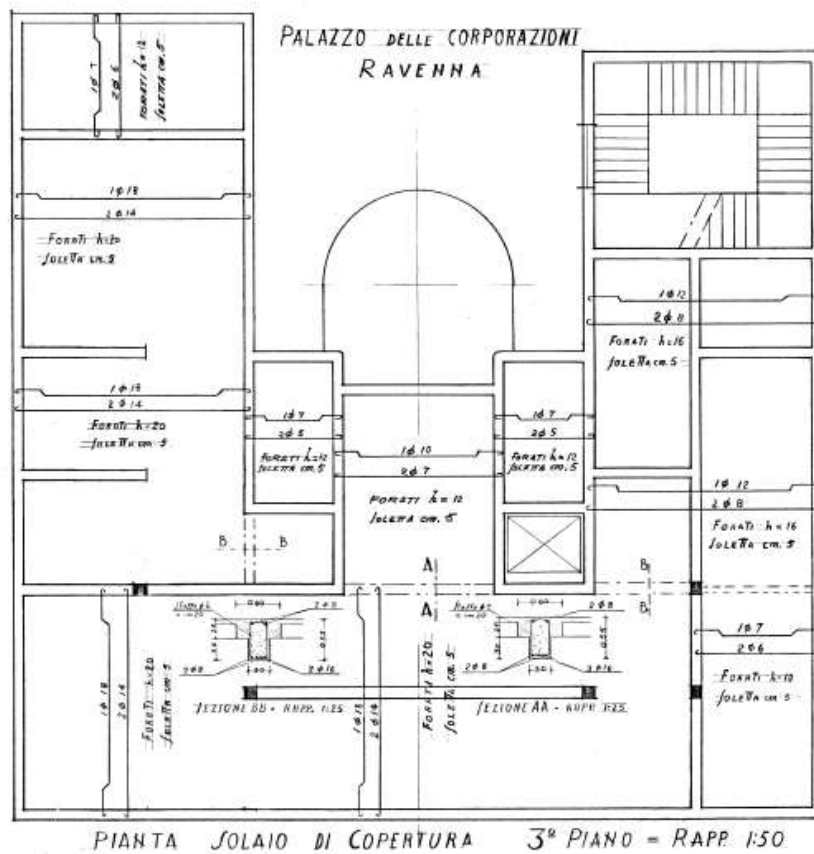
Pianta solaio di copertura piano quarto (da progetto preliminare), con indicazione delle travi in c.a.
